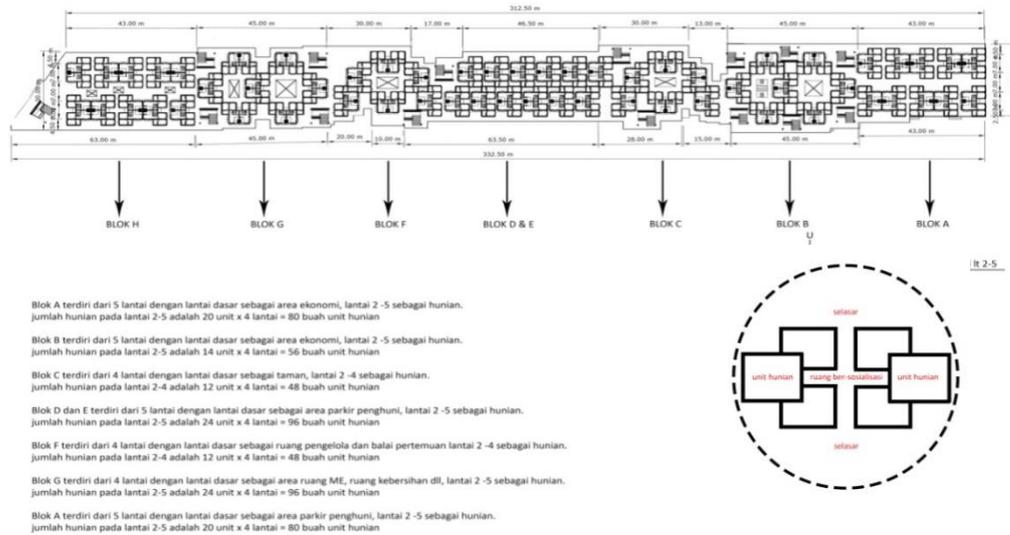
Bentuk masa bangunan sesuai kondisi eksisting tapak
